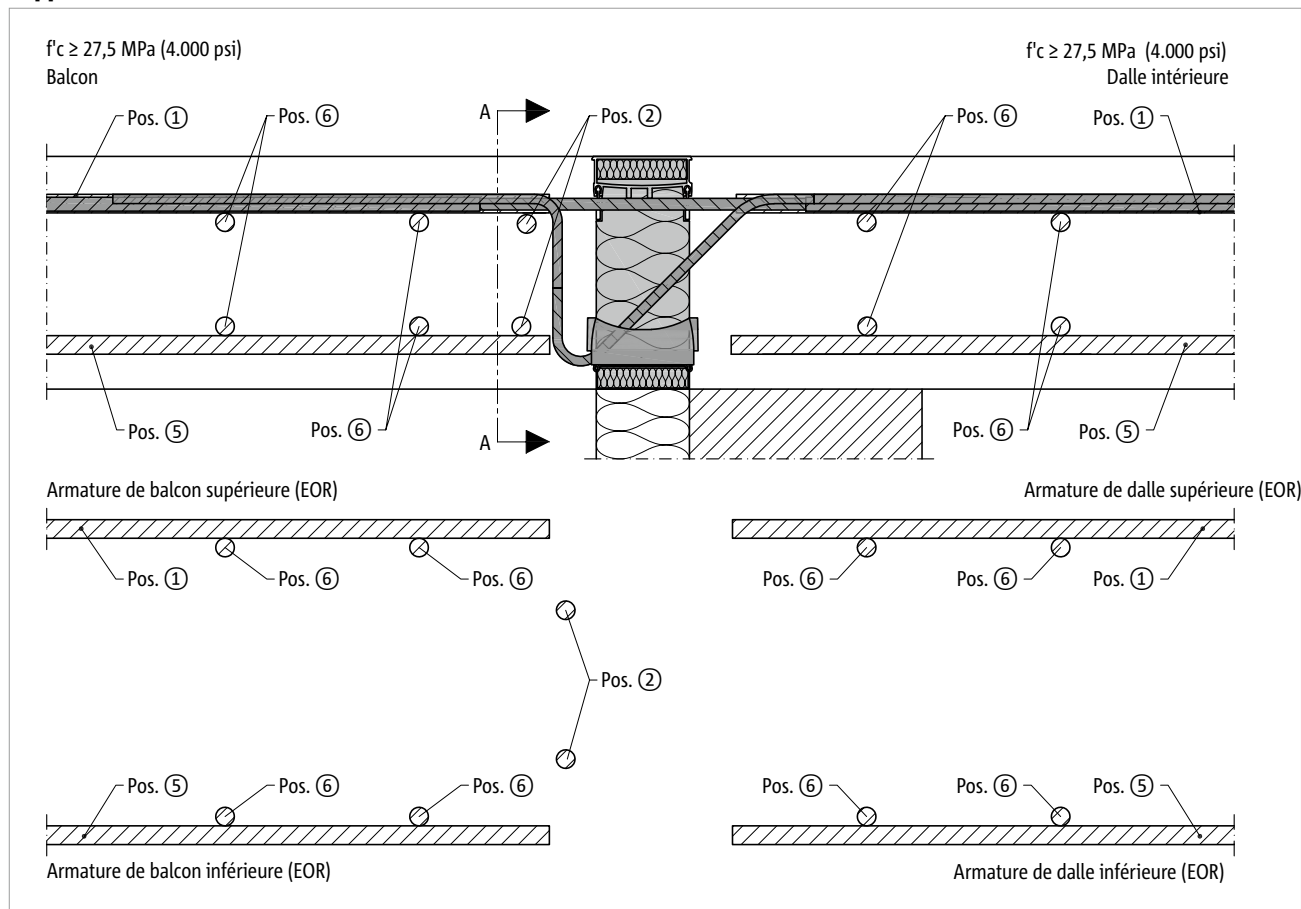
Schöck Isokorb® T Type CK : coupe transversale de l'armature recommandée pour béton coulé sur place (autre fournisseur) – support direct
